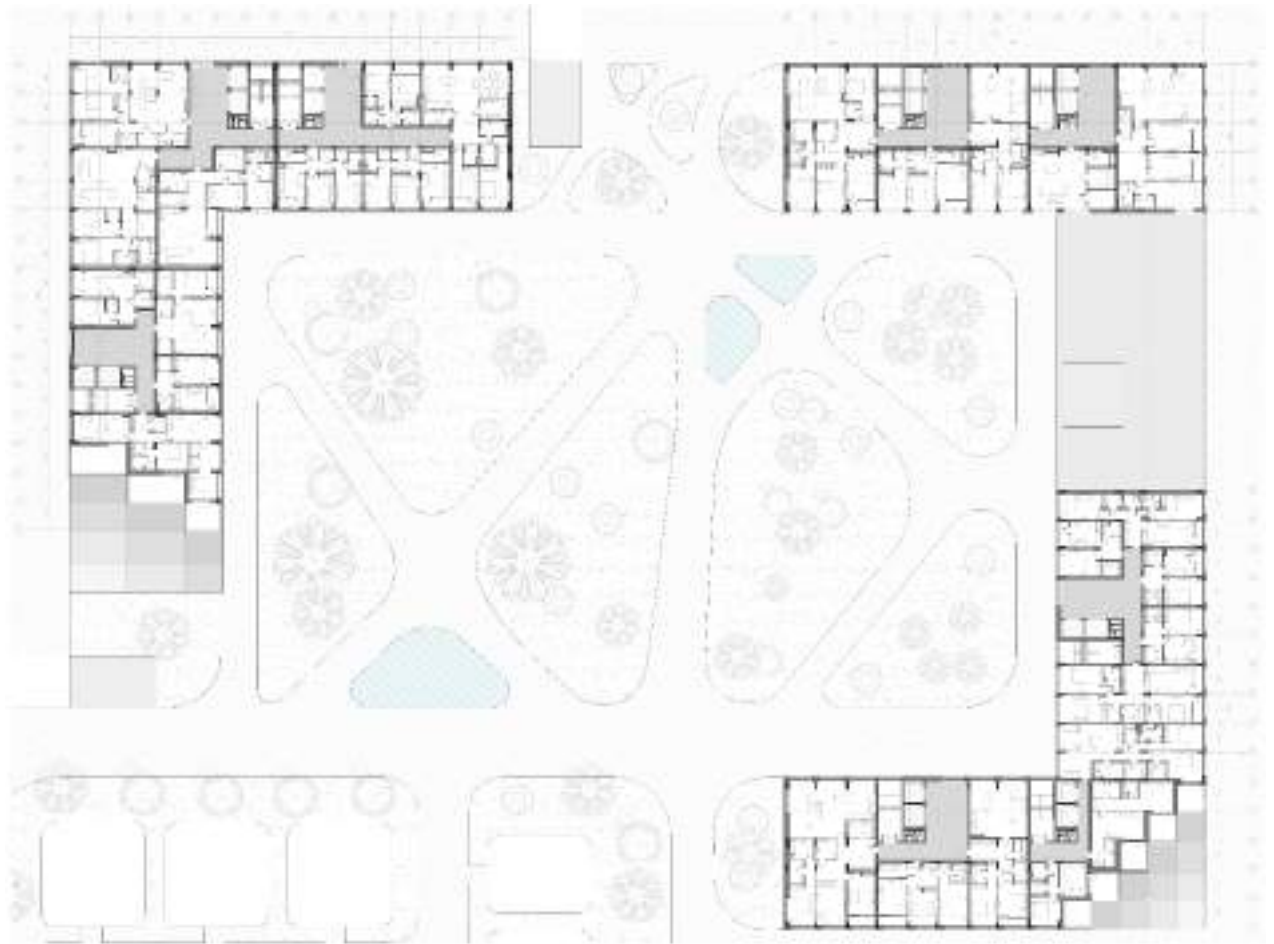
План нетипового поверху на відмітці +16,000
